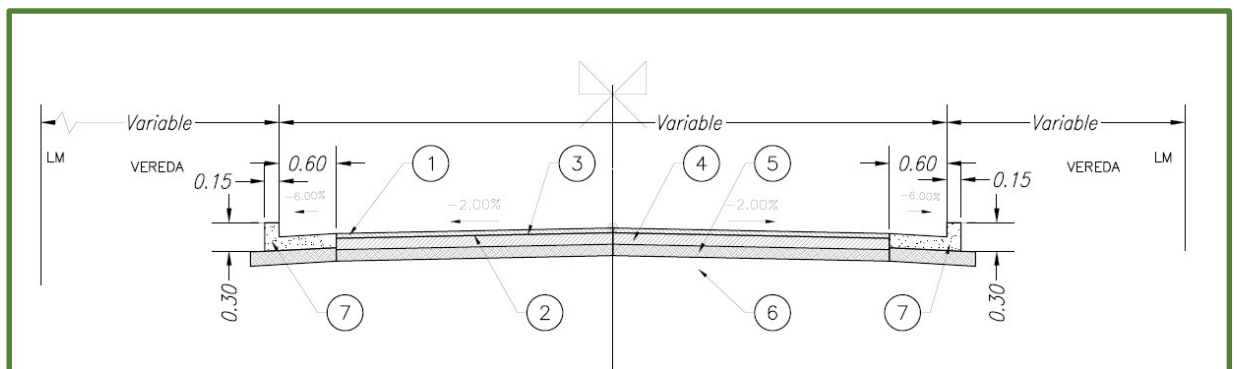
Perfil Tipo Pavimento Flexible para Calles (Municipalidad de Córdoba)
